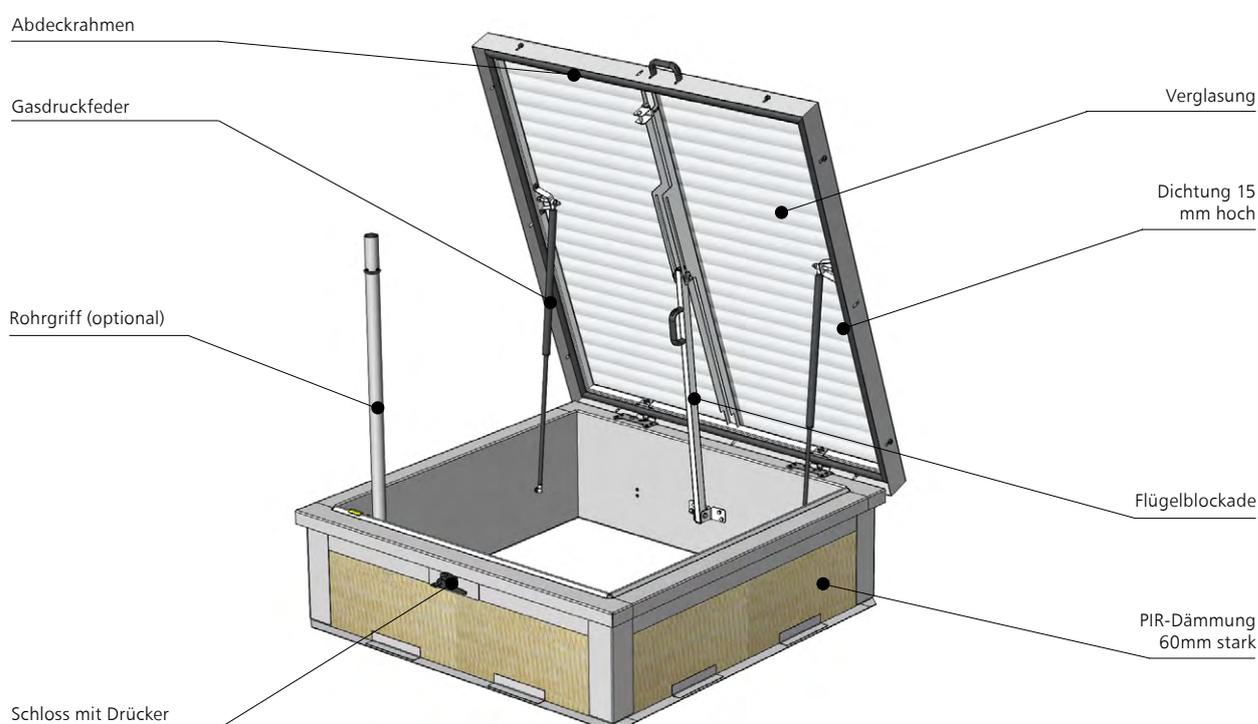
Aufbau eines Flachdachausstiegs mcr PROROOF LD zum Einbau über einer bauseitigen Leiter, ausgestattet mit auschiebbarem Rohrgriffwyjściowy
